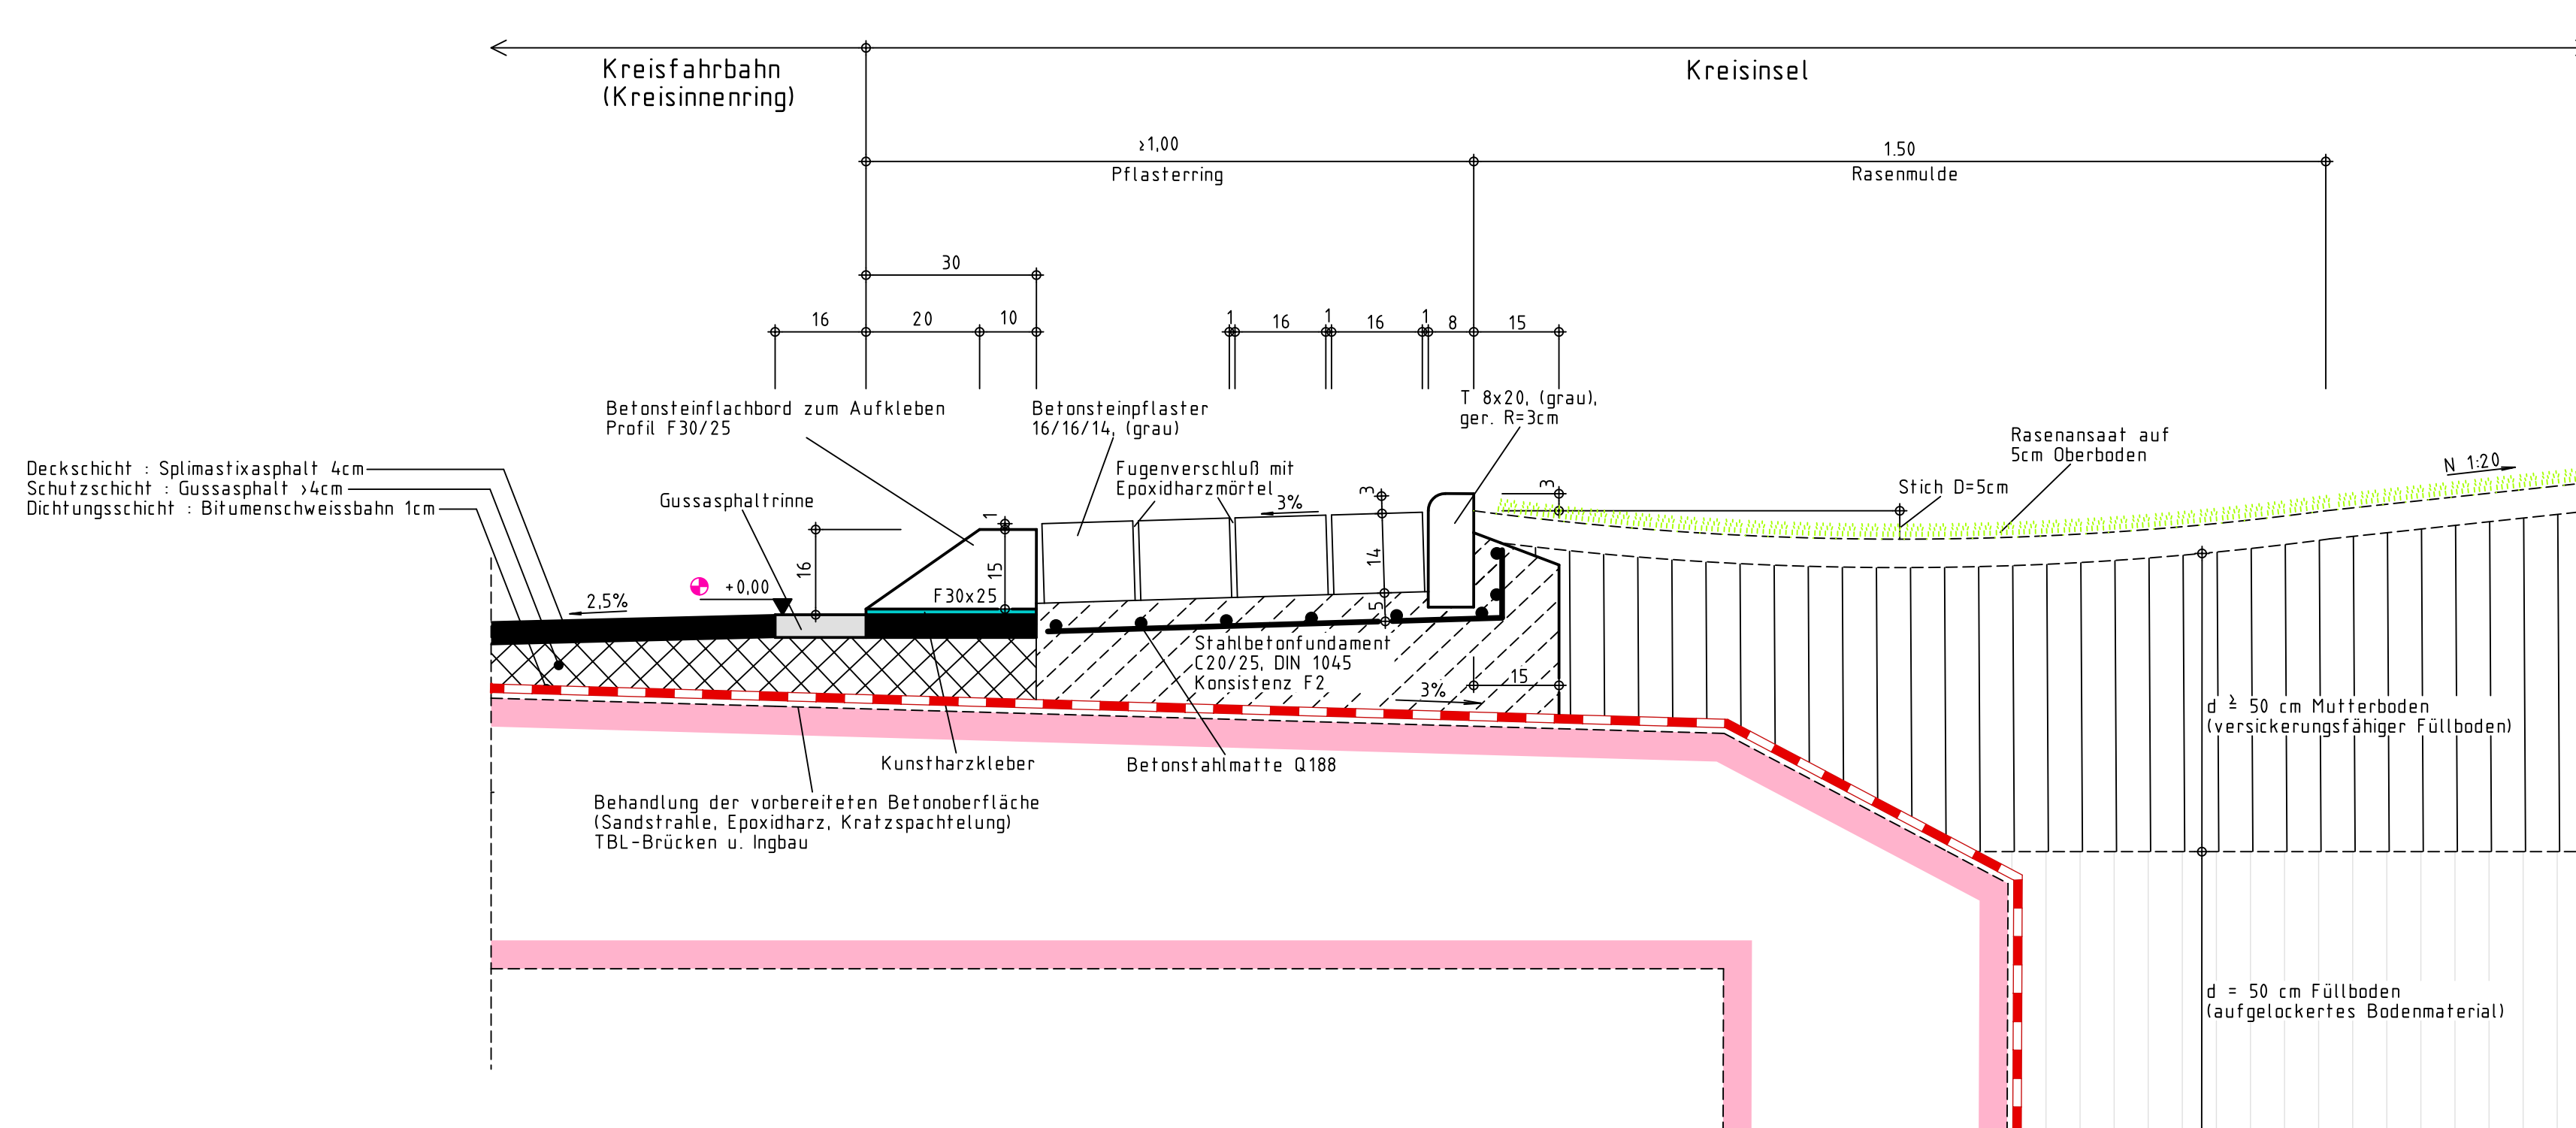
" Kreisinnening (Außerhalb der Bauwerkschale)
